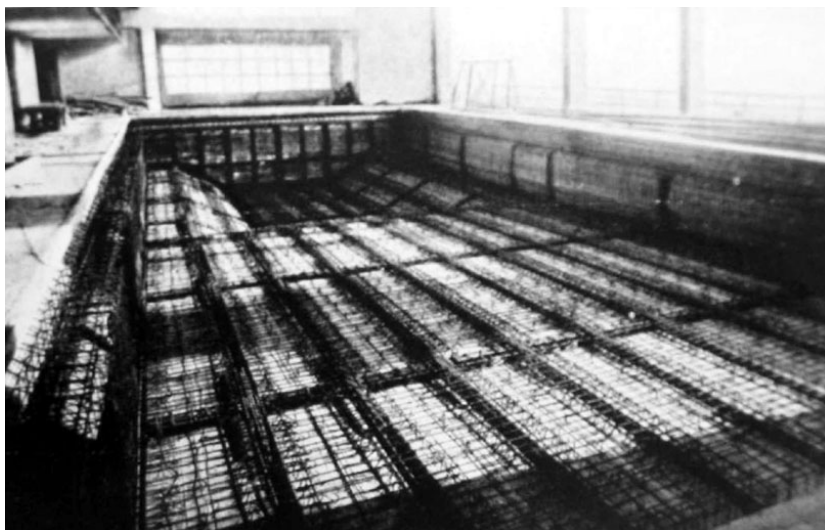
vista dalla torre del binario per la gru e zona culturale, primo solaio.
